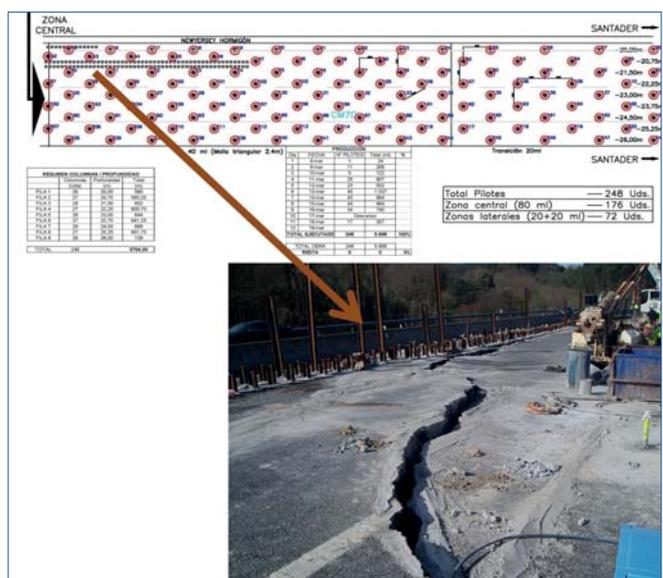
Planta del tratamiento de pilotes de mortero realizada.
